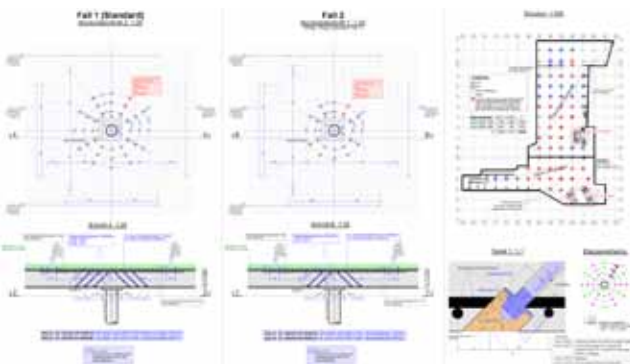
Схема расположения узлов, требующих усиления плиты перекрытия от продавливания.
